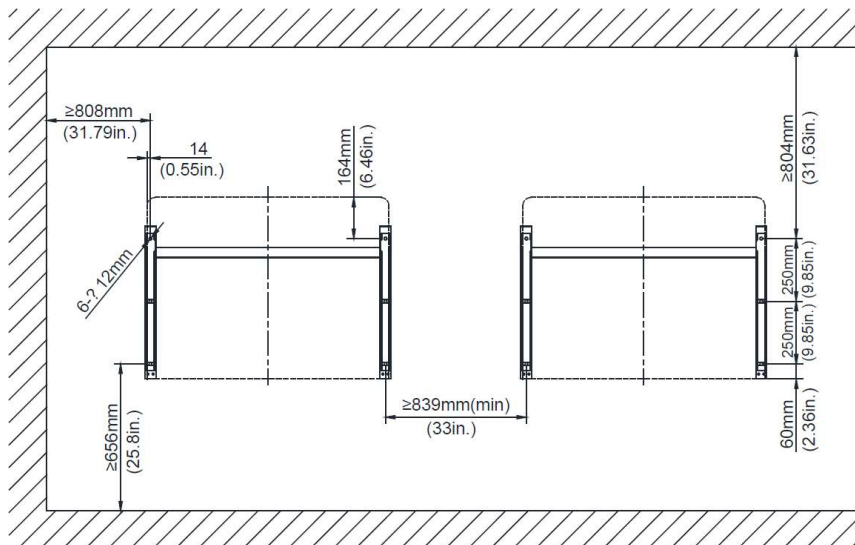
Dimensiones de la posición de los orificios de varios soportes de montaje
